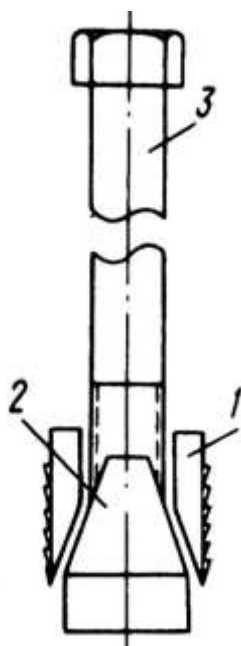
Анкер с механическим креплением для скальных грунтов; 1 – распорные щеки, 2 - клиновидный наконечник, 3 – тяга
